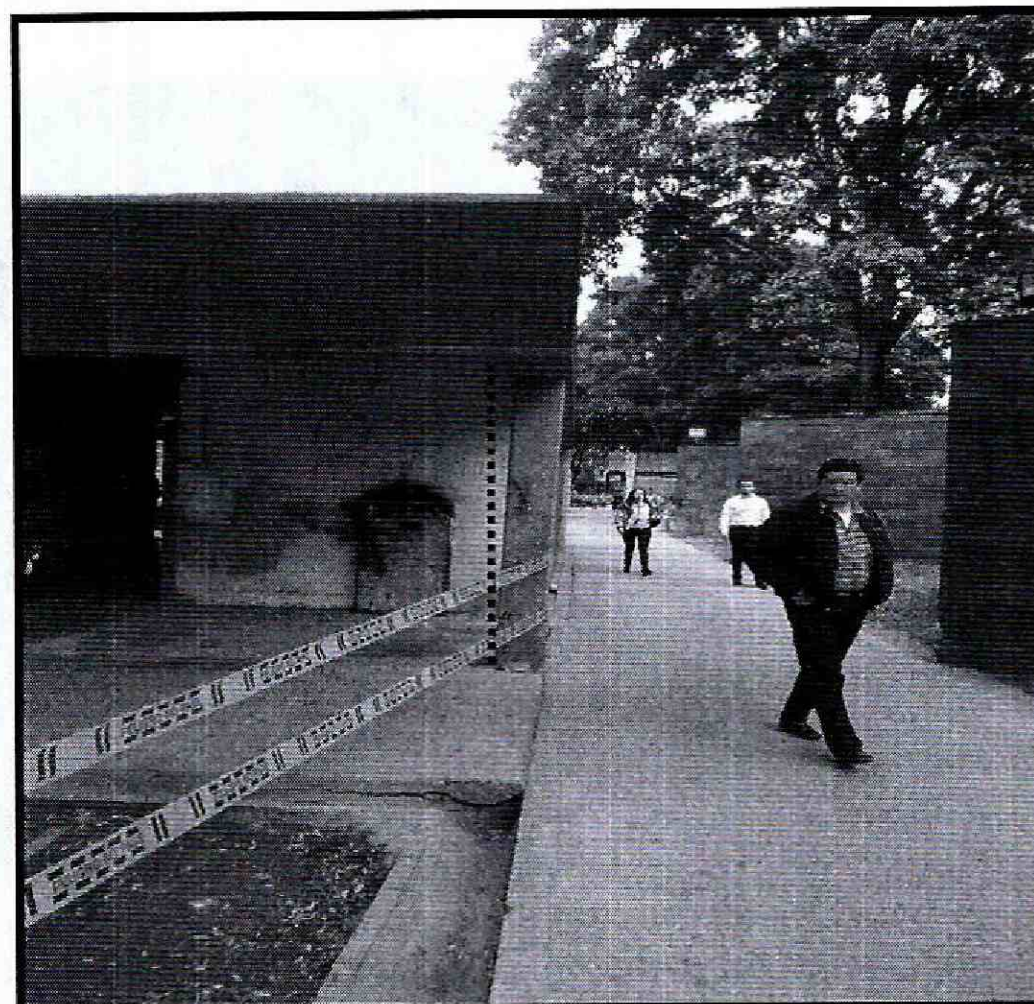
Separación entre los elementos estructurales y los muros de mampostería en el costado posterior de la edificación emplazada en del predio de la de la Diagonal 23 No 69-87 Interior 1, en el Sector Terminal de Transportes de la Localidad de Fontibón
